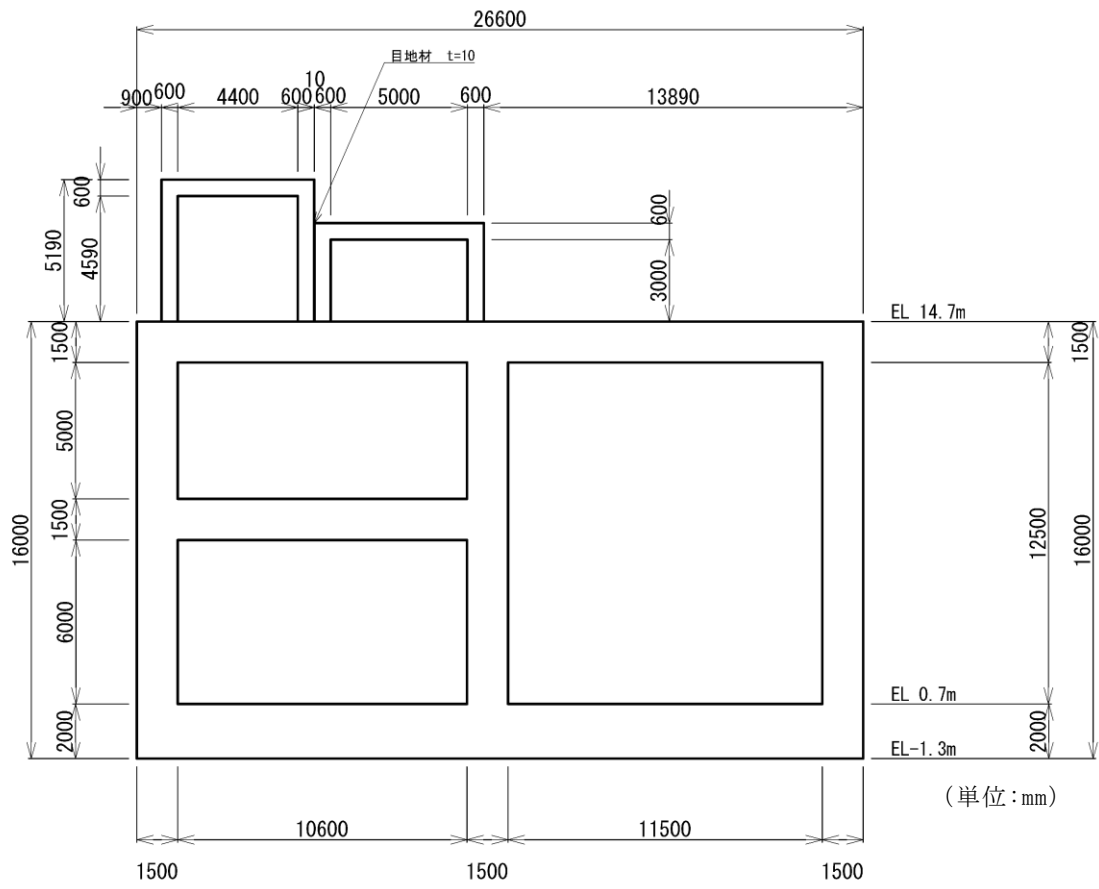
低圧原子炉代替注水ポンプ格納槽 断面図 (C-C断面)
